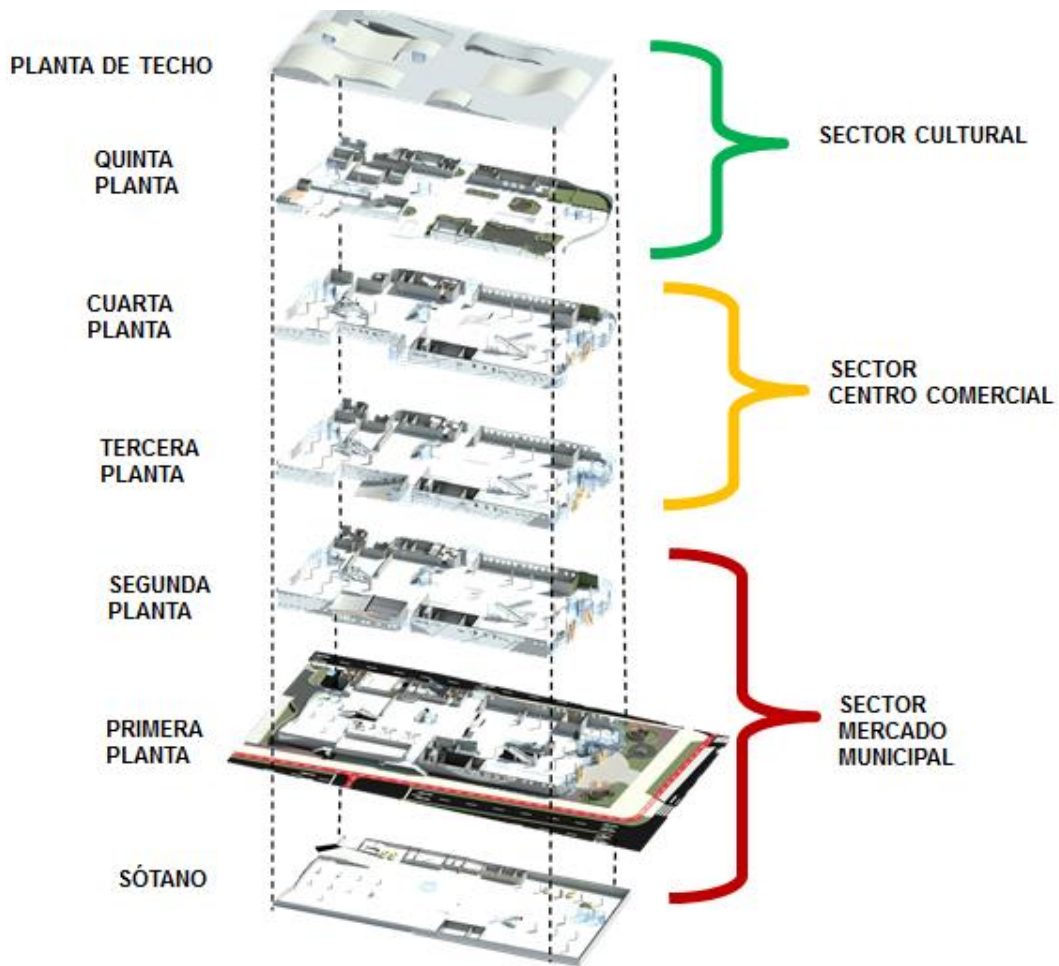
Distribución de los sectores en plantas. Fuente: Elaboración propia
